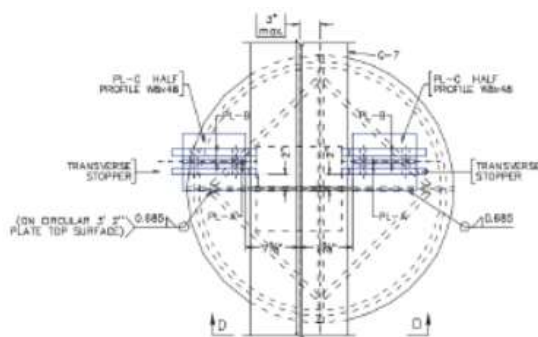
Detalle de tope transversal de la viga G7 de la plataforma de descarga en posición de máxima excentricidad.
